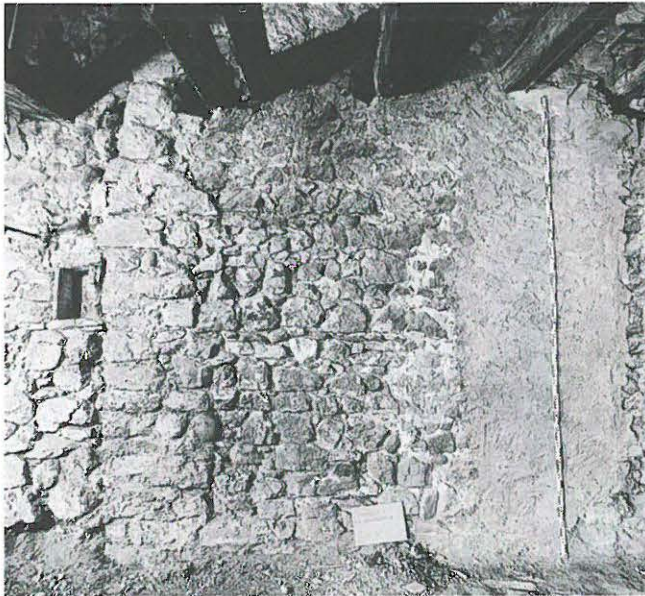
La Neuveville, Rue du Beauregard 16. Rez-de-chaussée mur (2).
